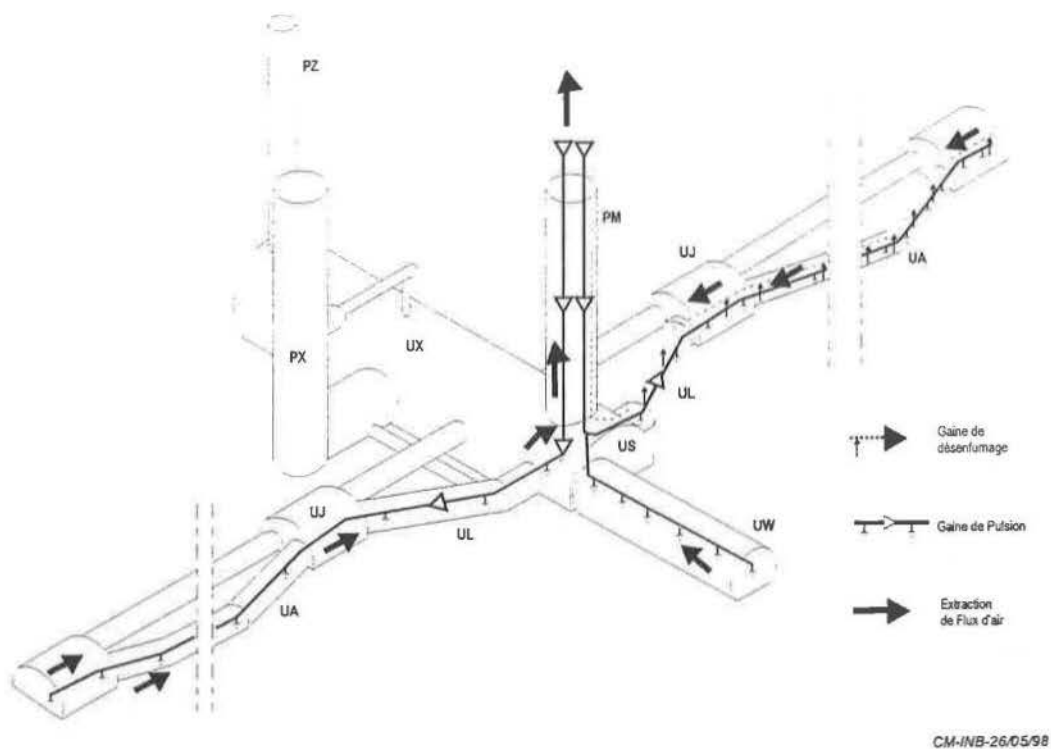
Ventilation des zones techniques accessibles/non accessibles
